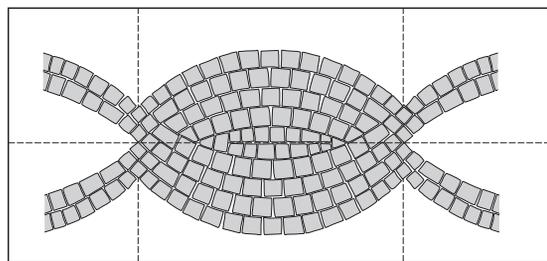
Changement d'orientation d'un appareillage mosaïque au point bas du profil longitudinal de la chaussée (œil de bœuf)
